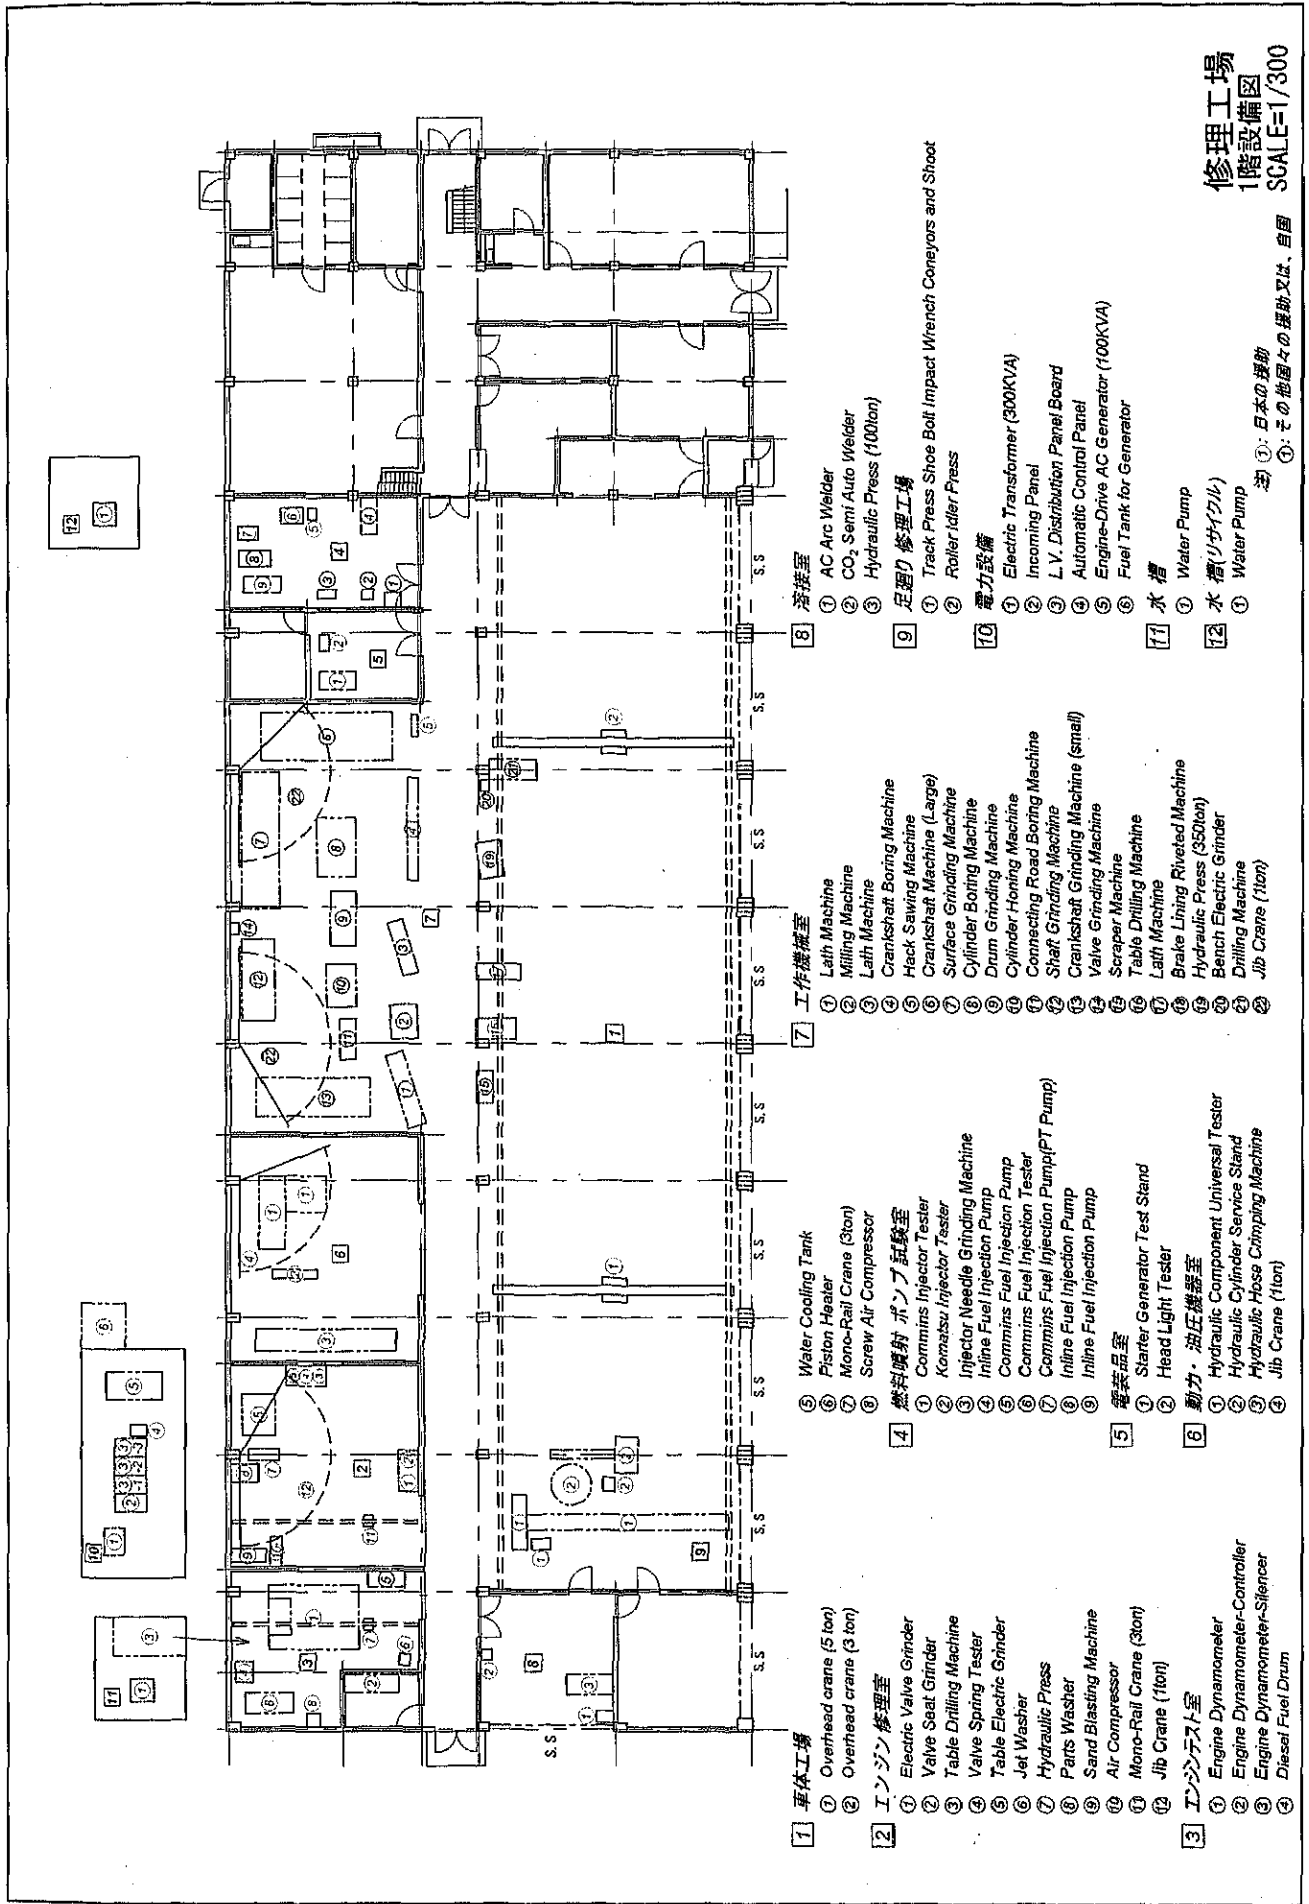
修理工場・1F 平面図 (建屋平面図)
